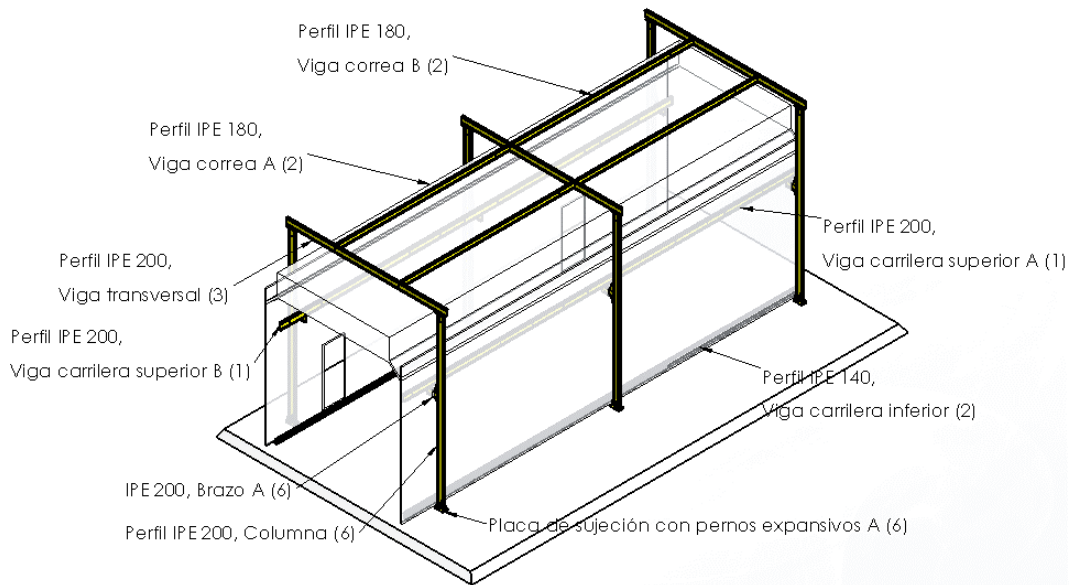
Estructura exterior para el soporte del sistema general de traslación y elevación
